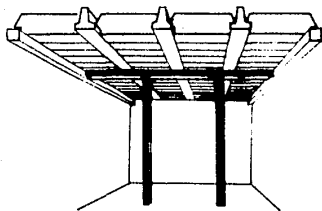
SECUENCIA DE MONTAJE Y TERMINADO DE LA LOSA CON SISTEMA DE VIGUETA Y BOVEDILLA
